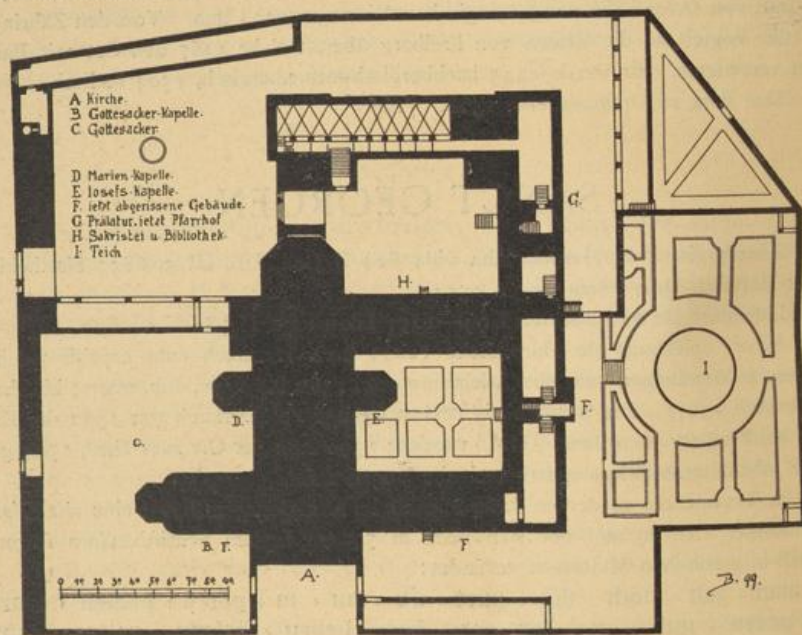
S. Märgen. Grundriss des Klosters mit eingeseichneten Kelleranlagen.
